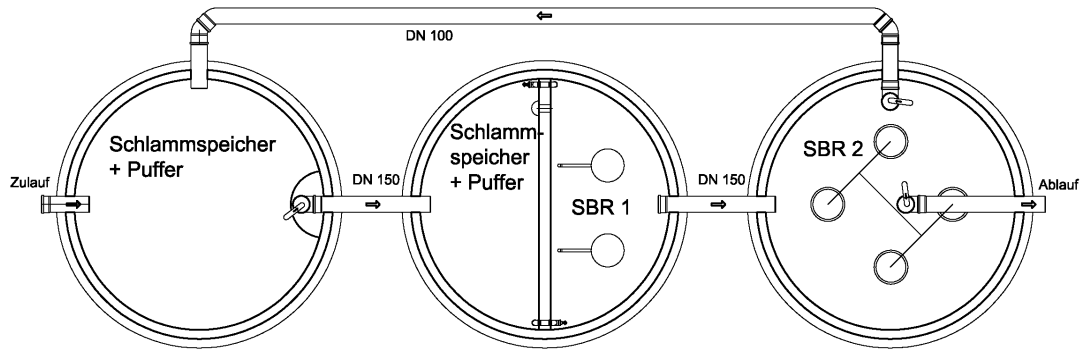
Schematischer Grundriss einer Dreibehälteranlage
